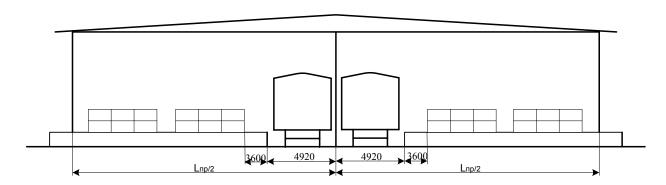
Поперечный разрез двухпролетного крытого склада
